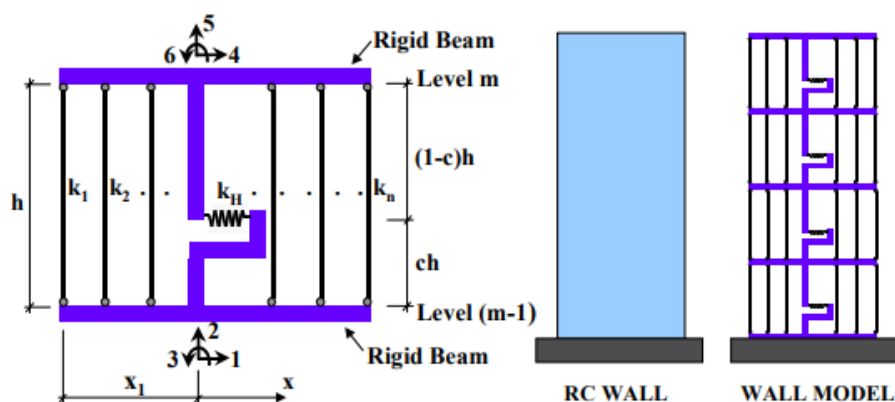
Elementos tipo paneles del MVLEM (Orakcal & Wallace, 2002)
